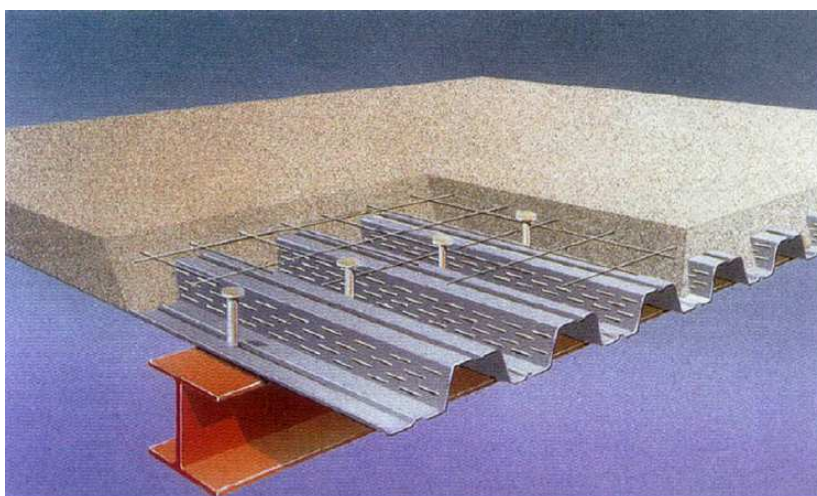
Exemplo do sistema de lajes mistas- Steel Deck CE-75 – catálogo CODEME
